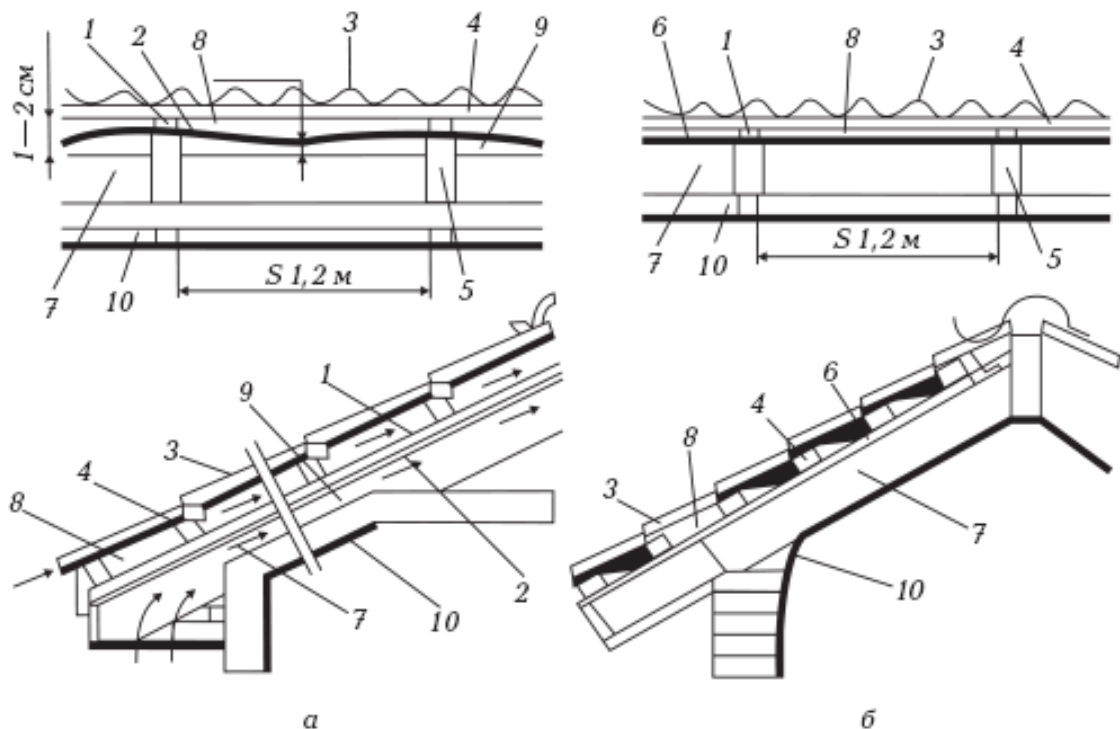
Конструкция гидроизоляции кровельного «пирога»: а) пленкой (с двумя вентиляционными зазорами); б) мембраной (с одним вентиляционным зазором); 1 – контробрешетка; 2 – гидроизоляционная пленка; 3 – кровельное покрытие; 4 – обрешетка; 5 – стропило; 6 – мембрана; 7 – утеплитель; 8 – верхний вентиляционный зазор; 9 – нижний вентиляционный зазор; 10 – пароизоляция
